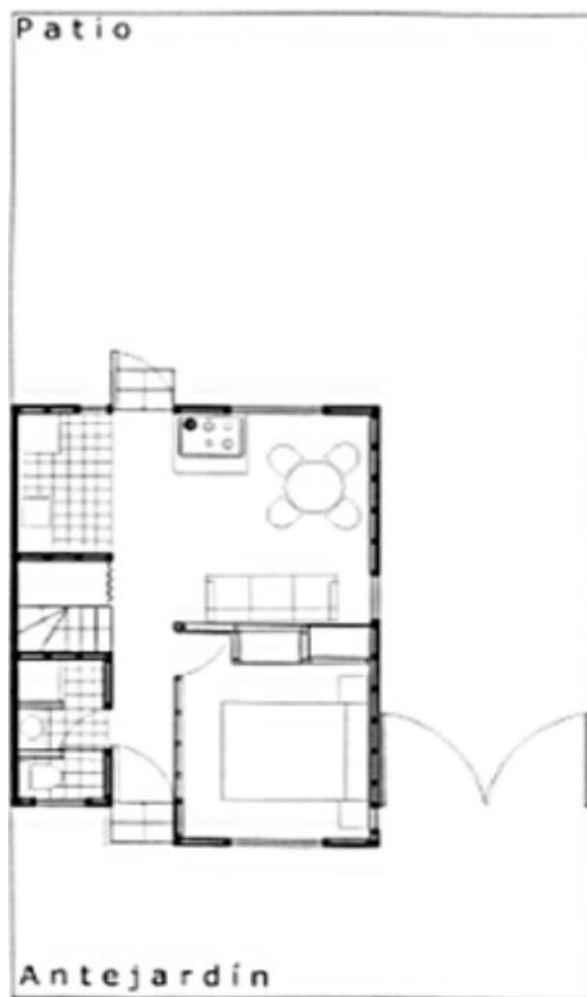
Vista en planta casa pareada, Altos de Rahue, Osorno.
